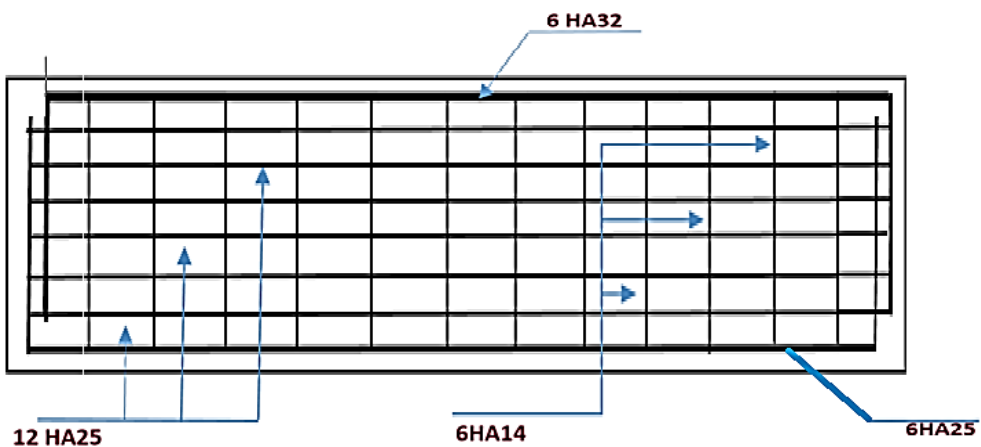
FERRAILLAGE DE CHEVETRE
